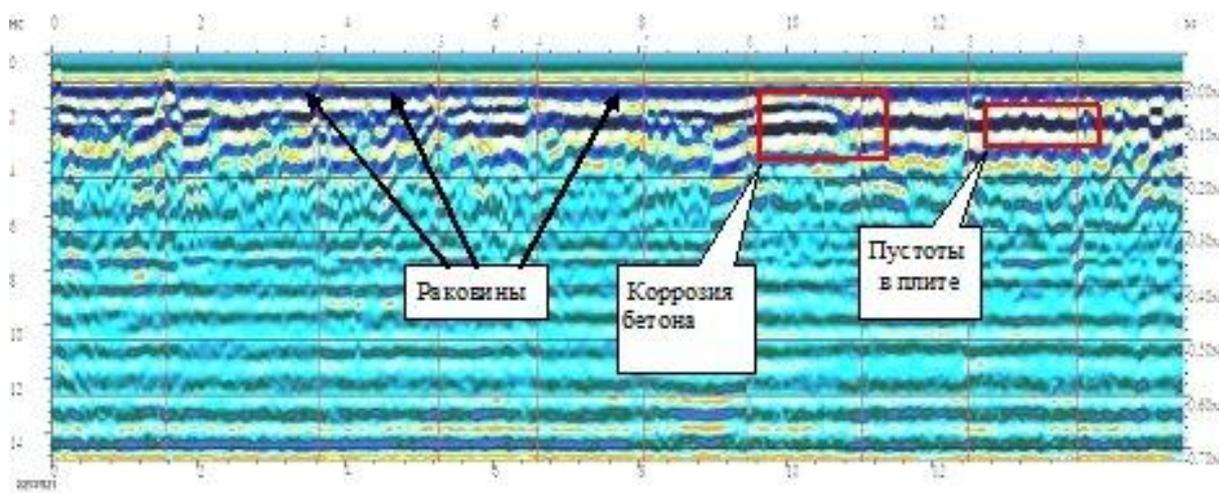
Фрагмент профиля георадарного зондирования облицовочных бетонных плит
